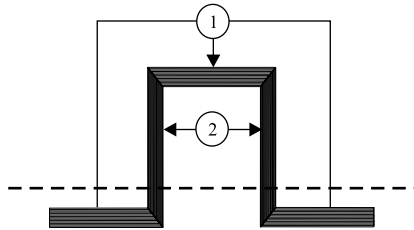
Esquema de una sección general de un perfil, indicando láminas tipo 1 (horizontales) y tipo 2 (verticales)
